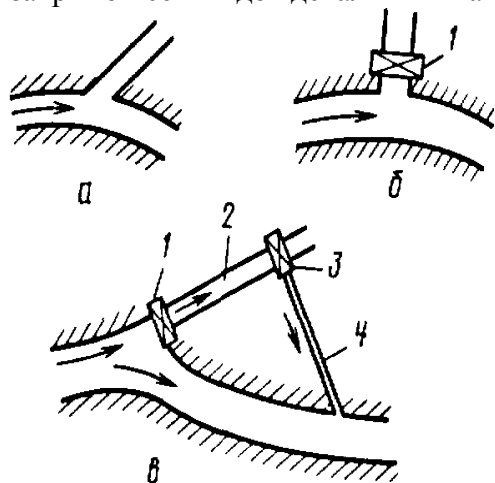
Схемы бесплотинных водозаборных узлов: а – неотшлюзованный без отстойника; б – отшлюзованный без отстойника; в – с головным шлюзом-регулятором в начале отстойника и шлюзом-регулятором с донными промывными отверстиями в конце отстойника; 1 – головной шлюз-регулятор; 2 – отстойник; 3 – шлюз-регулятор с донными промывными отверстиями; 4 – сбросной канал.
